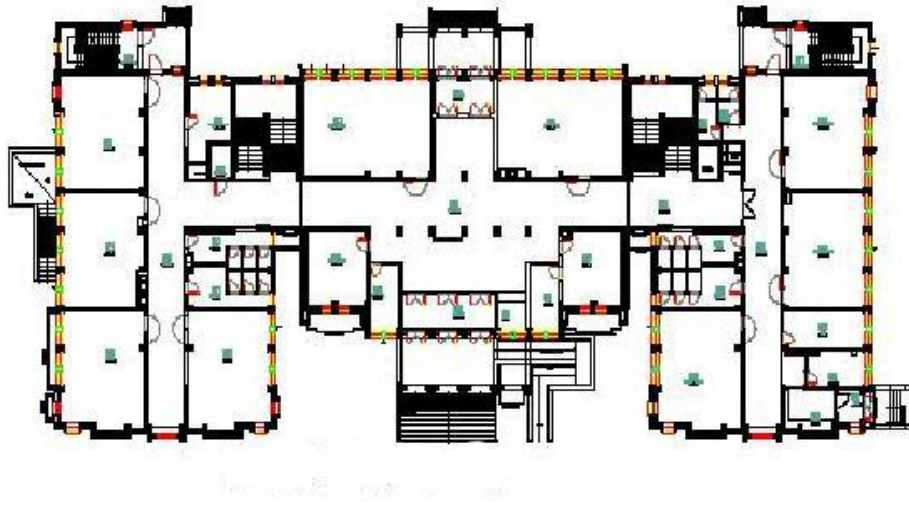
Alpaslan İ.Ö.O. vaziyet planı
